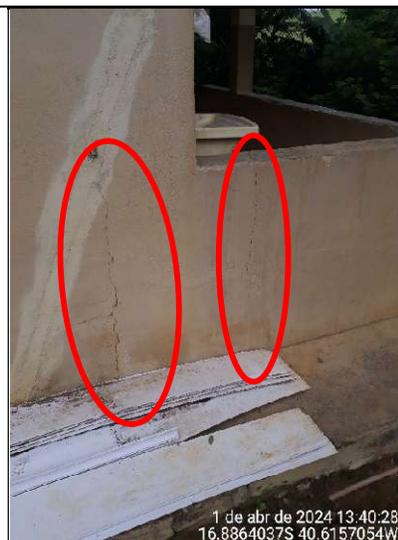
Detalhes de rachadura e trinca na parede, lado externo
